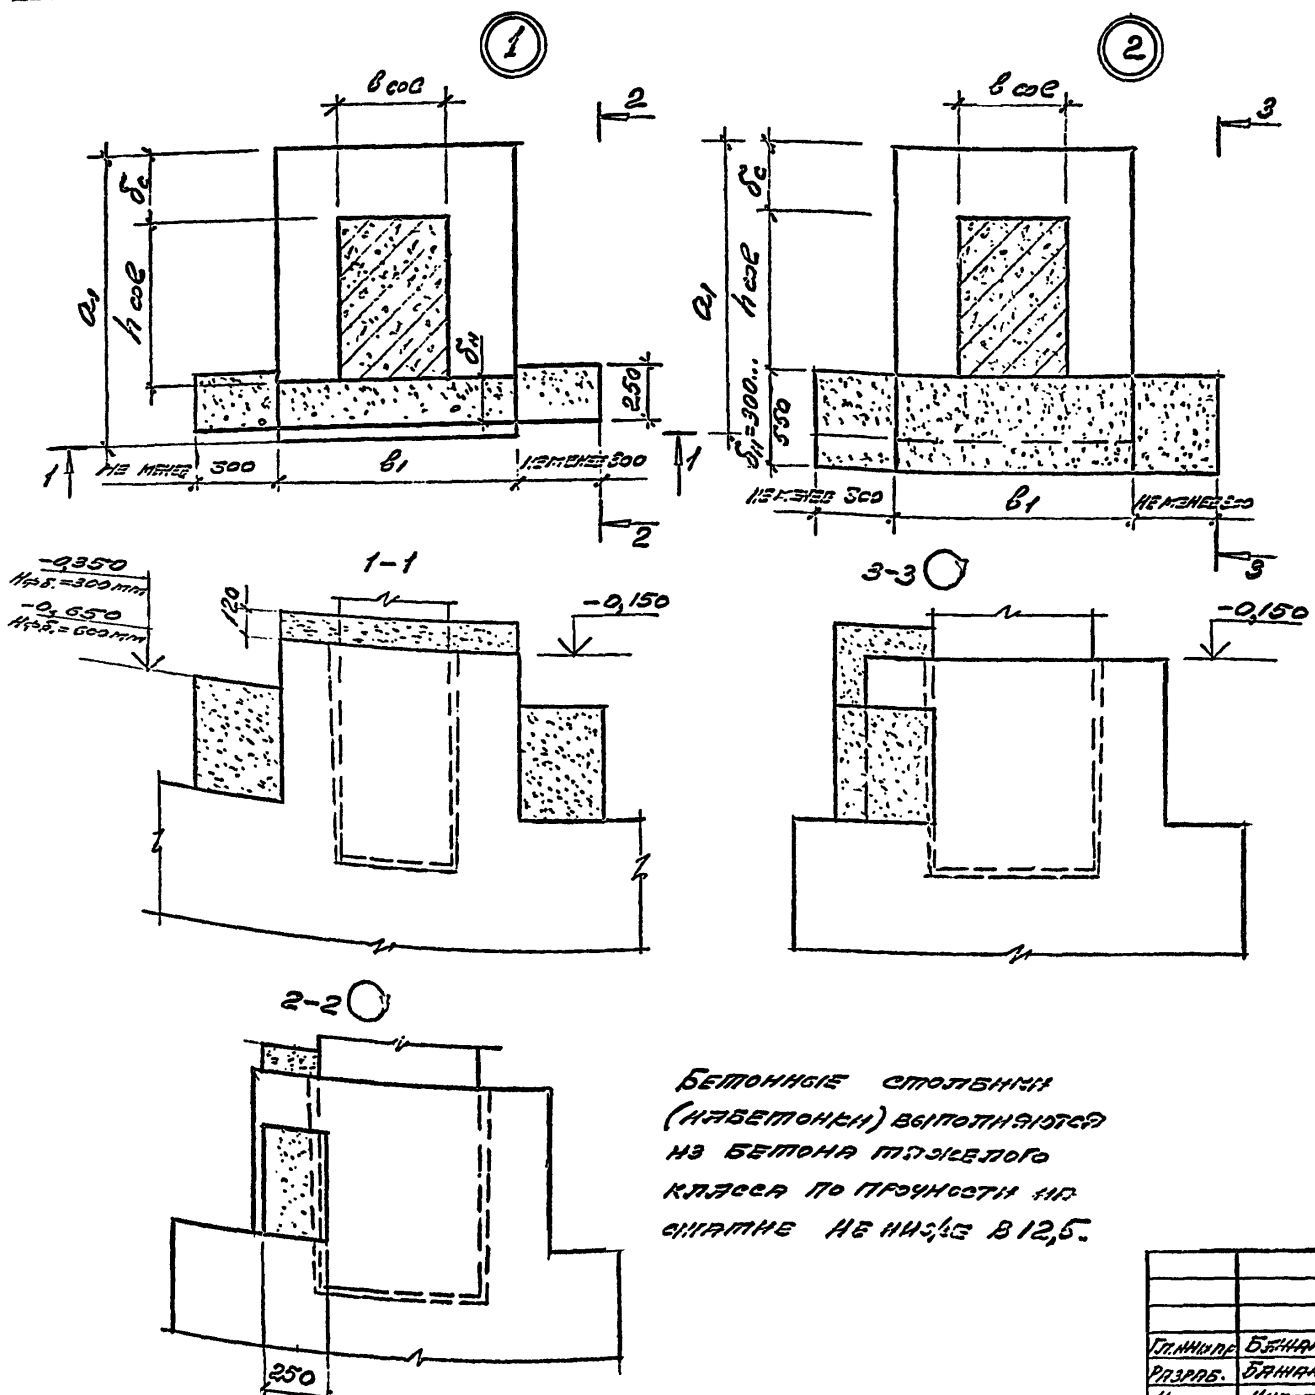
Узел опоры фундаментов с блока на ростверж под рядовую колонну крайнего ряда. На плане фундаментов связевого блока (разрез 1-1) армирование роствергов условно не показано.
